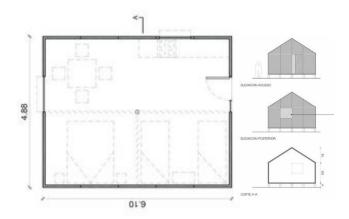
Planimetría Casa Elemental Tecnopanel. Fuente: Plataforma Arquitectura.
